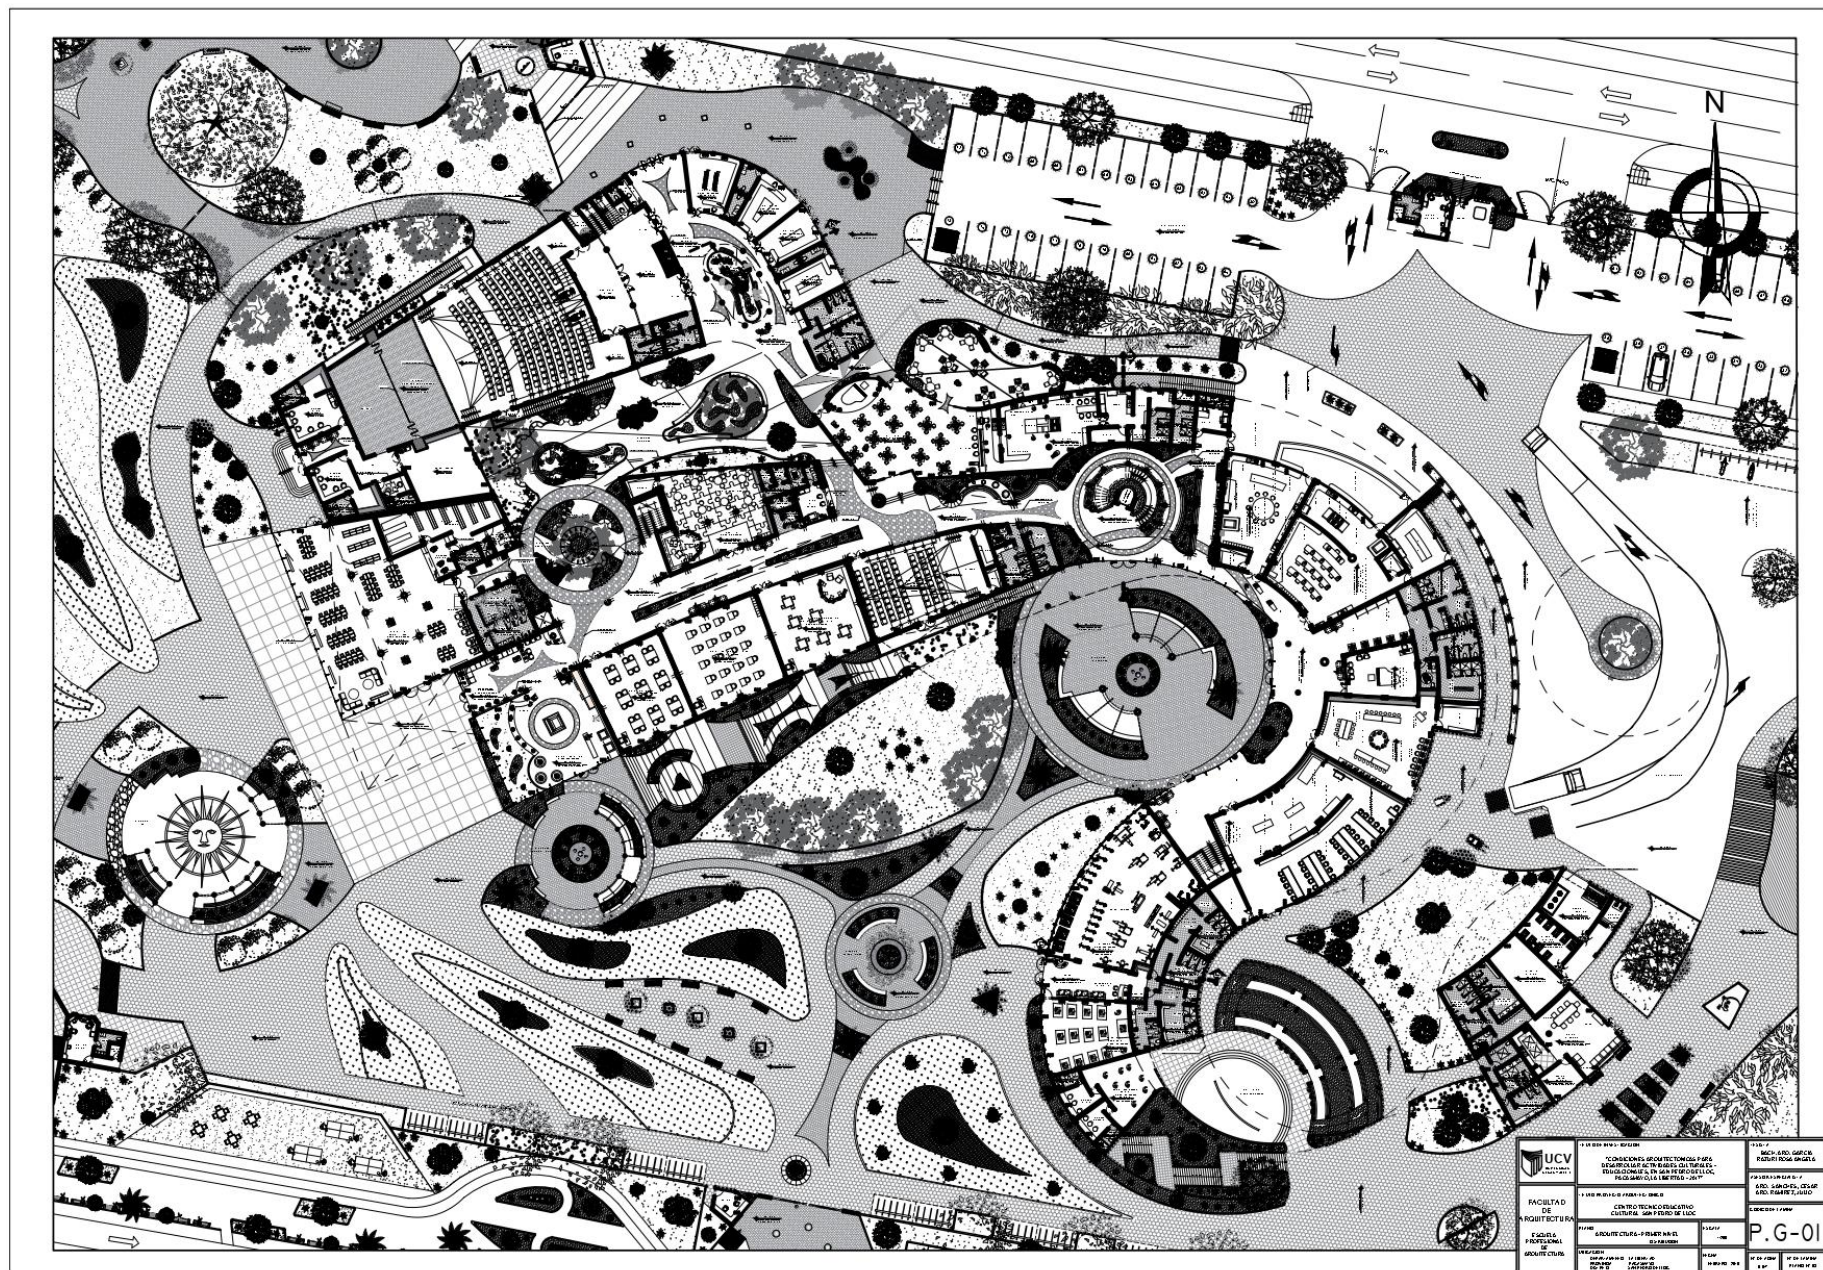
Plano de Distribución General 1er Nivel - Plano N° 08 - Lamina N°: P.G. - 01
